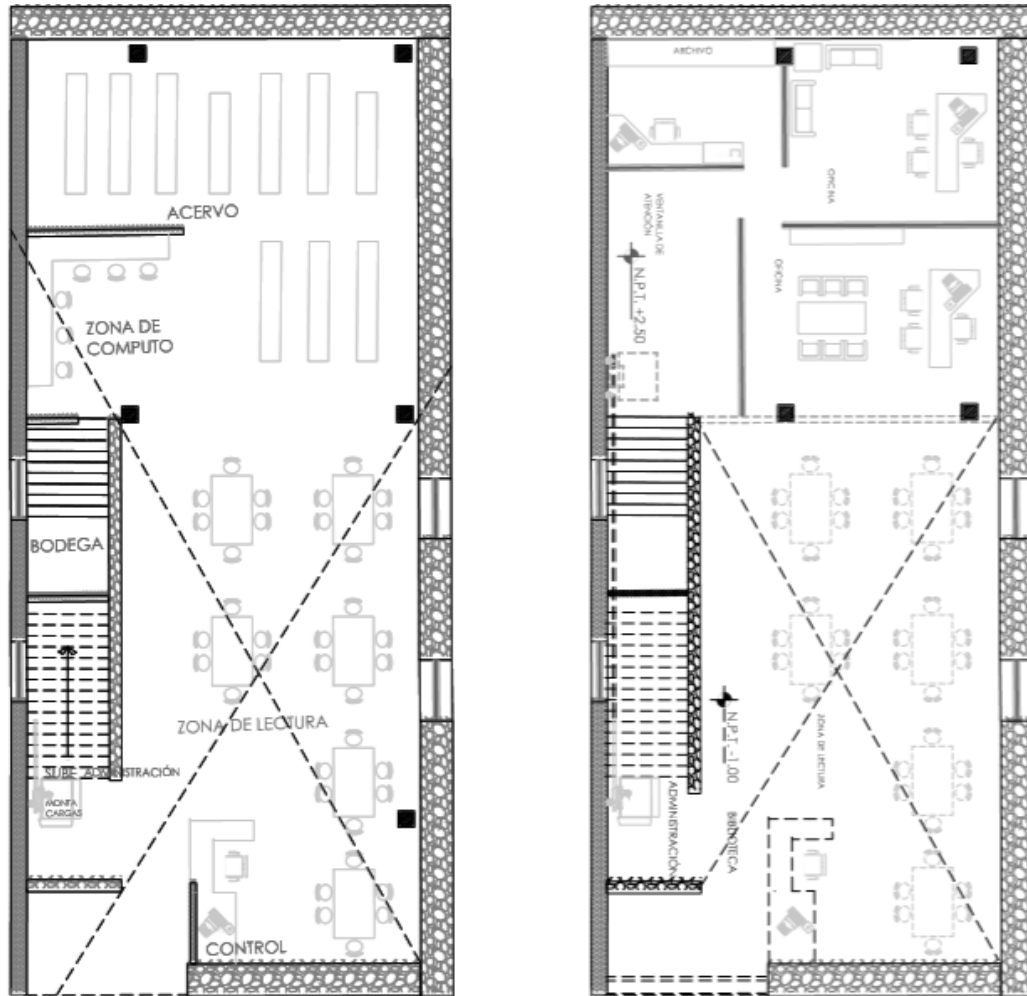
Planta arquitectónica de biblioteca y administración, Centro multidisciplinario Ex hacienda Cusi.
